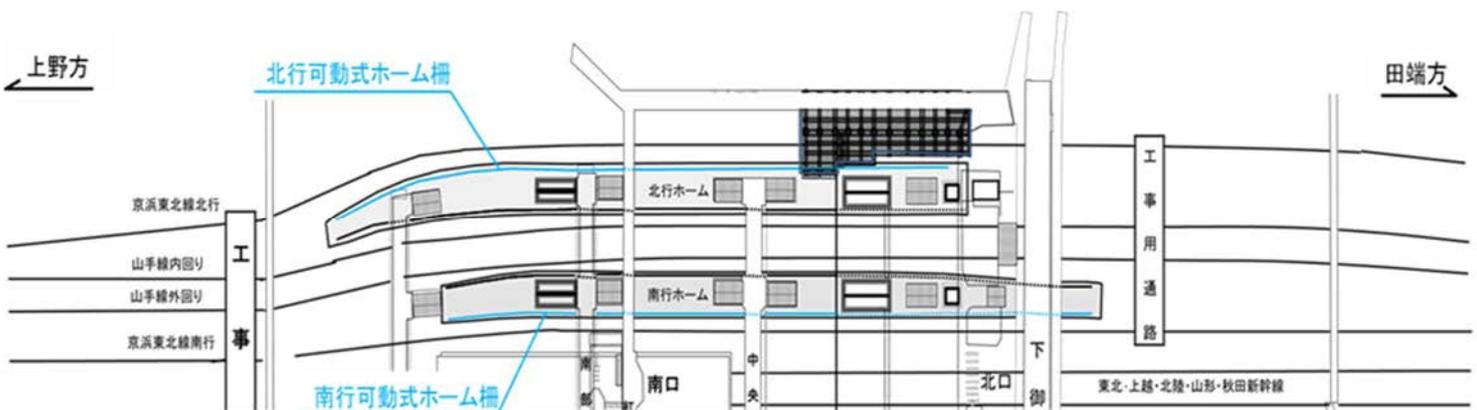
日暮里駅京浜東北線北行・南行ホーム平面図
